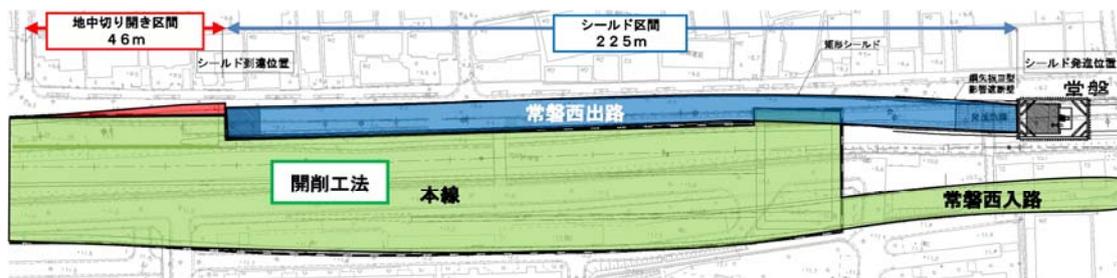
地中切り開き及びシールド区間（常磐西出路非開削工法区間）平面図
